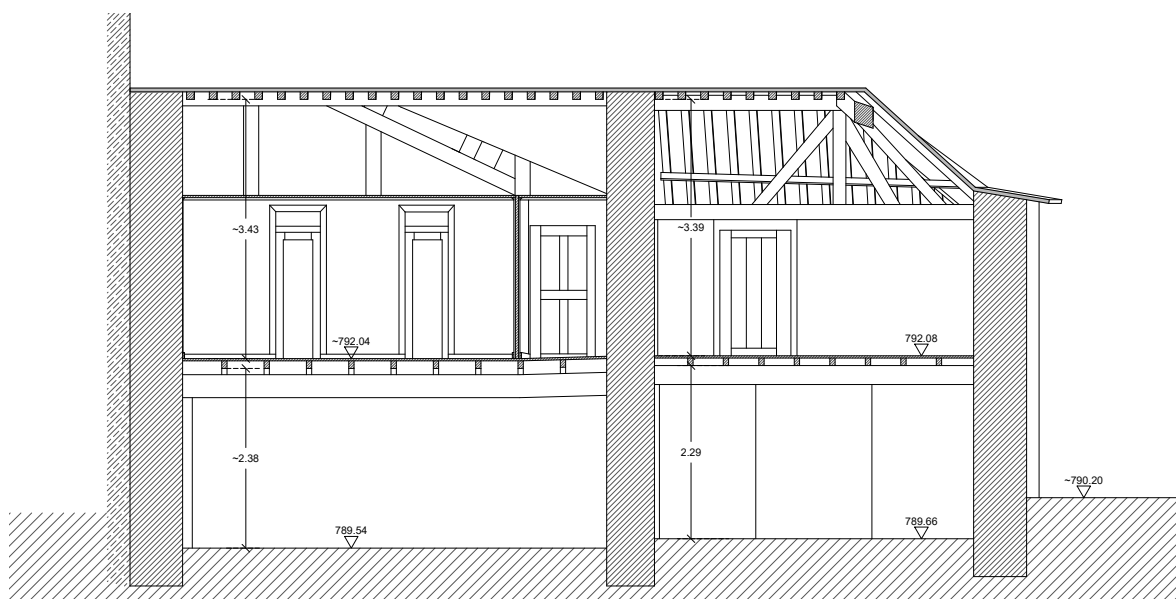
Corte 5 do levantamento. Escala 1:100.
